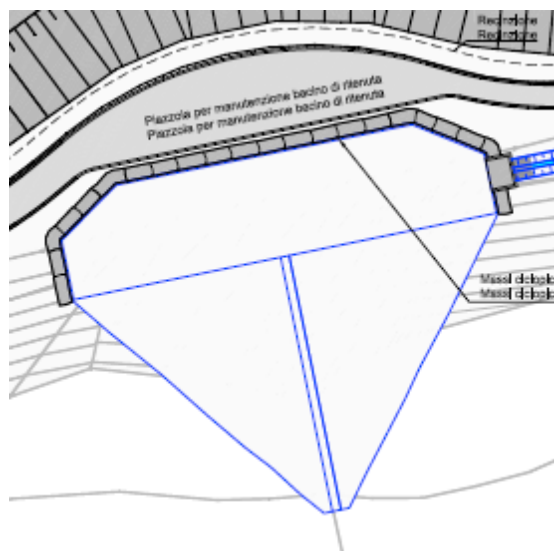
Rückhaltebecken – Lageplan, Detail
